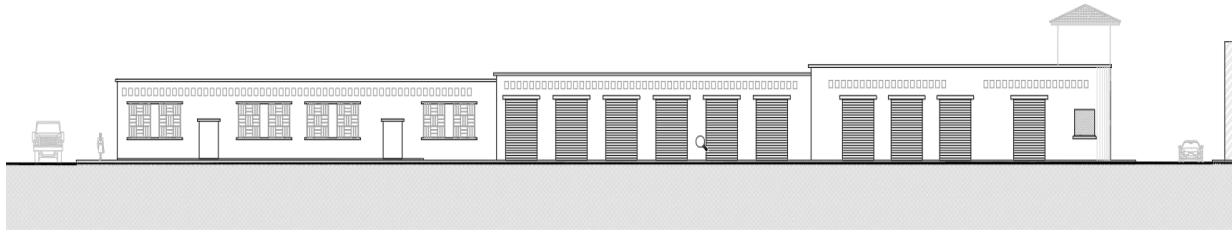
Fachada posterior plaza de mercado (Calle 12). Adaptación Fachada Actual.
